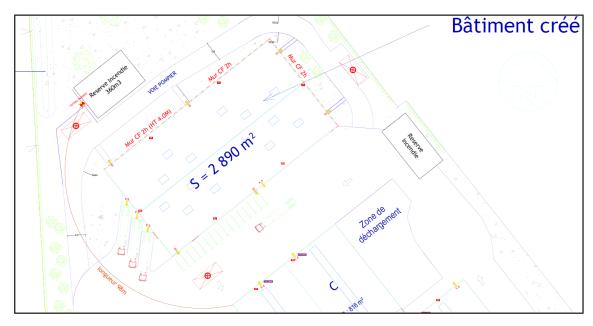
Localisation des murs coupe-feu futur bâtiment (source: sicabconstruction)
